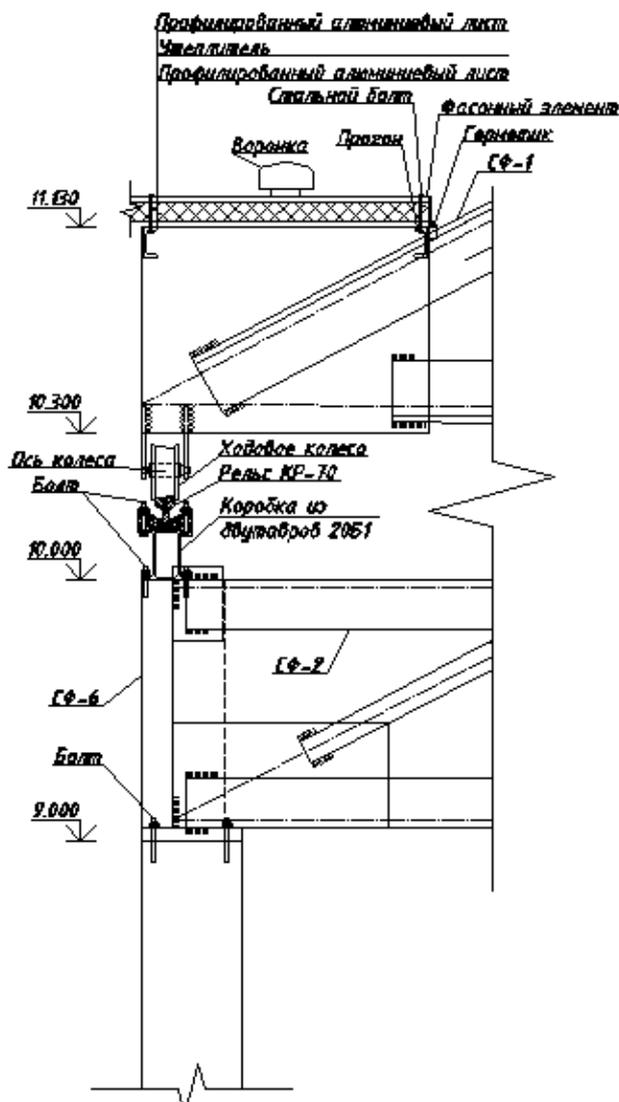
Узел крепления конструкции сдвижной кровли к колонне каркаса
